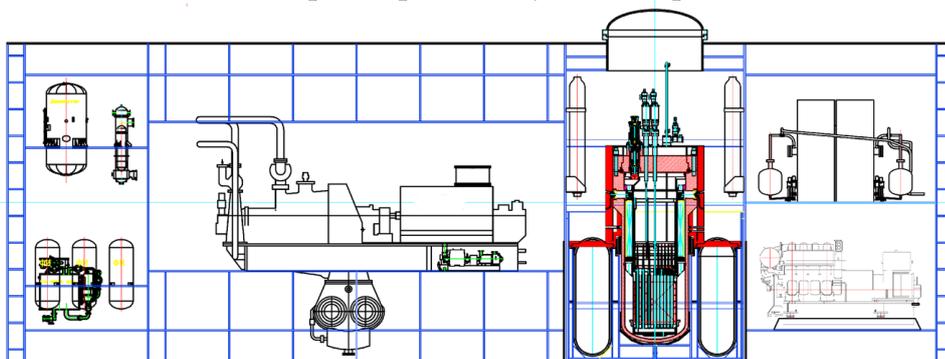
Общий вид реакторного модуля моноблочного БТЭБ
